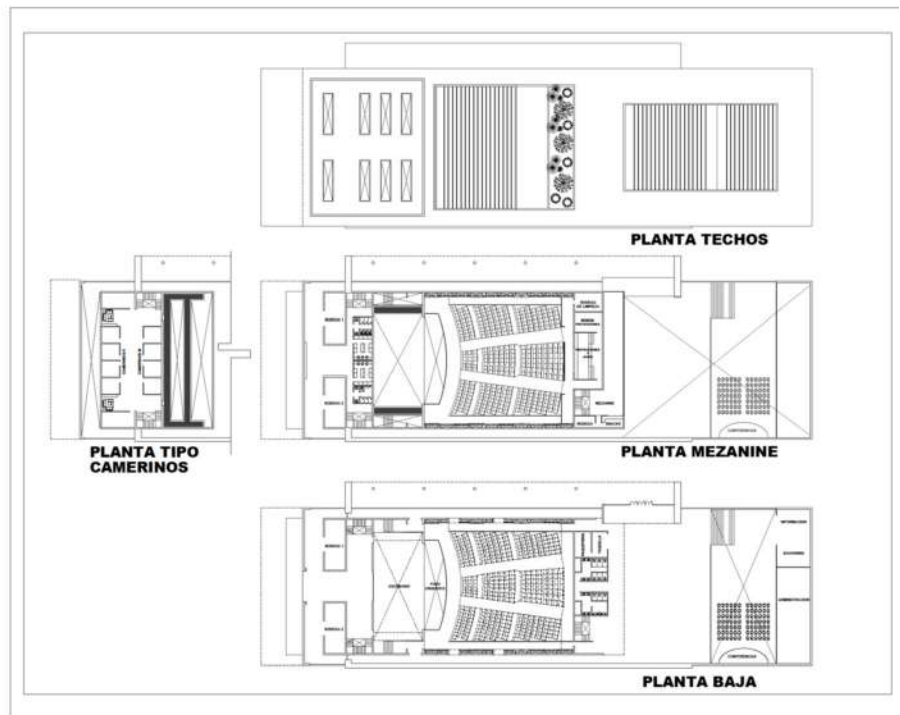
Planos arquitectónicos de antecedentes (Autoría propia)
